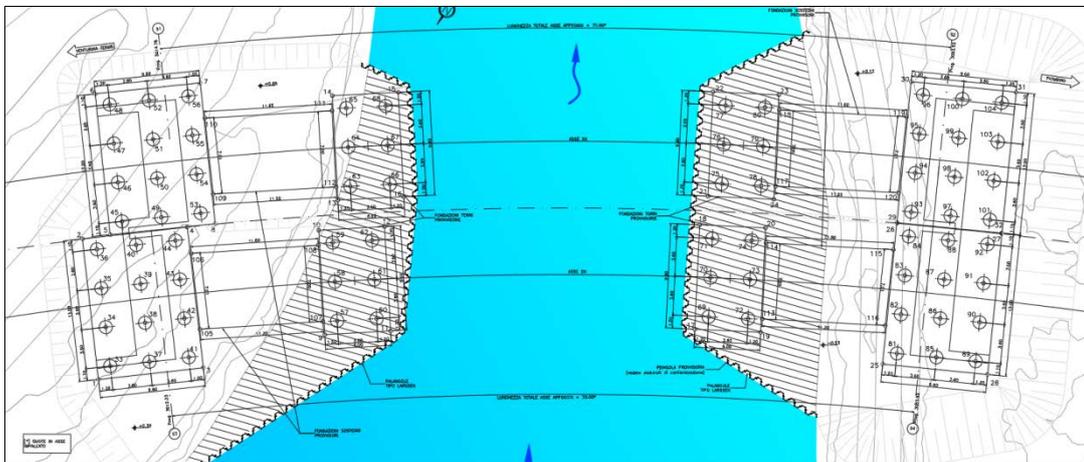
Pianta fondazioni (definitive e provvisorie)
